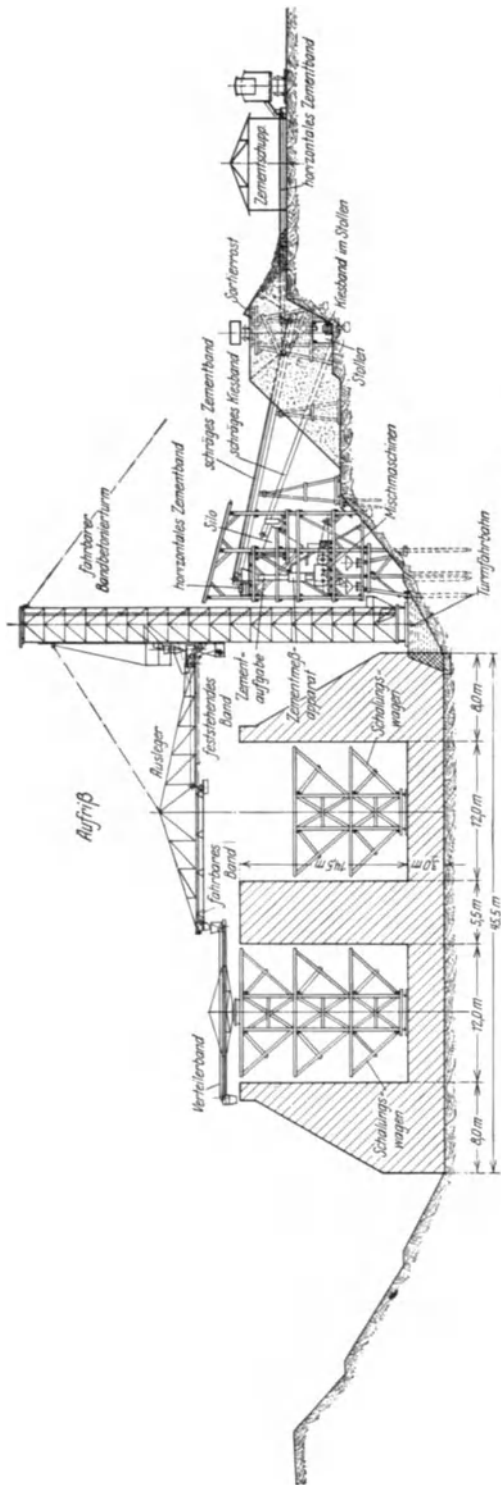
Querschnitt durch die Schleuse Ladenburg mit Betonierungseinrichtung.
